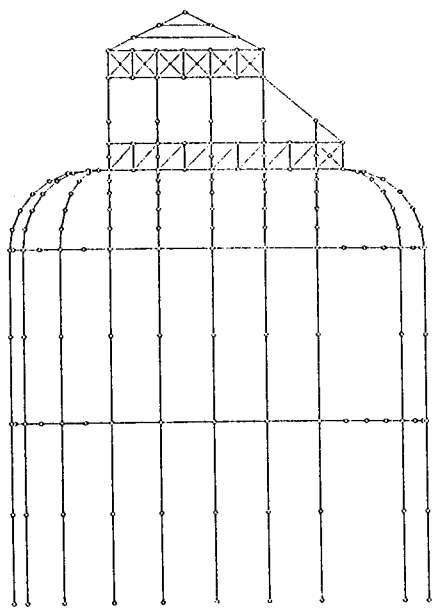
Shopent. Modelação estrutural: alçado longitudinal.
